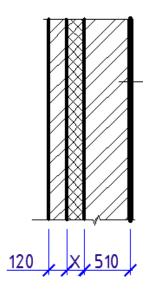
Предварительная (расчетная) конструкция стены Таблица 2 - Сводные данные для теплотехнического расчета стены
